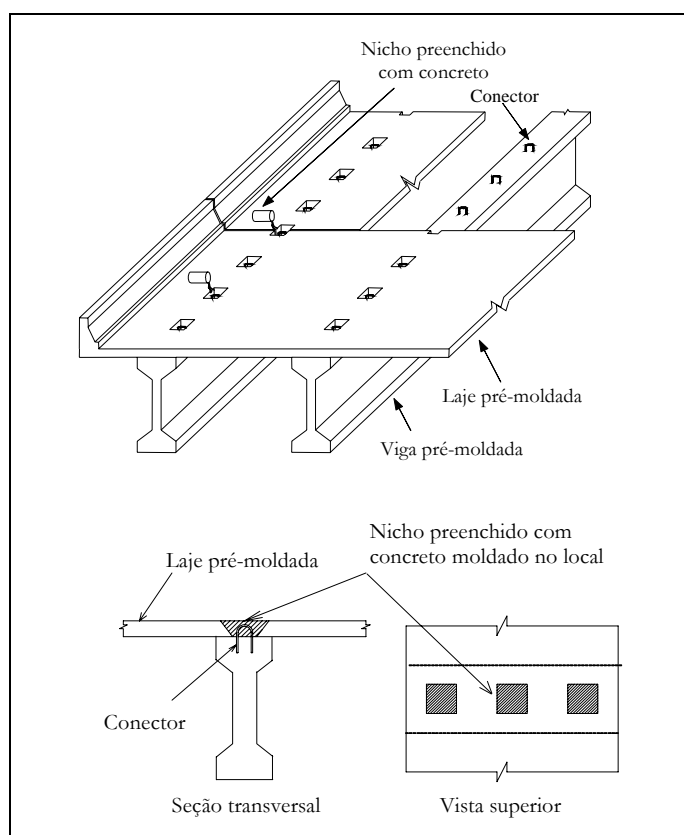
Ligação viga-laje em tabuleiros de pontes compostas pré-moldadas.
